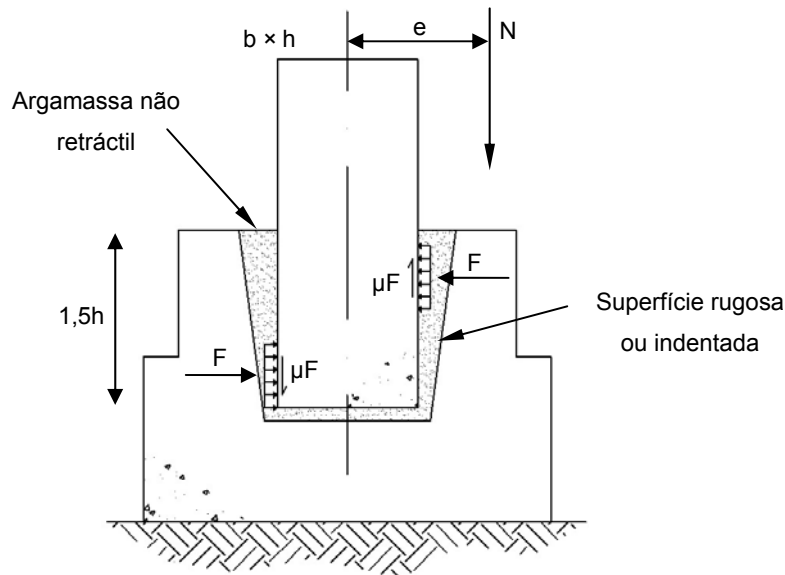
Ligação pilar – fundação em cálice, comportamento mecânico
